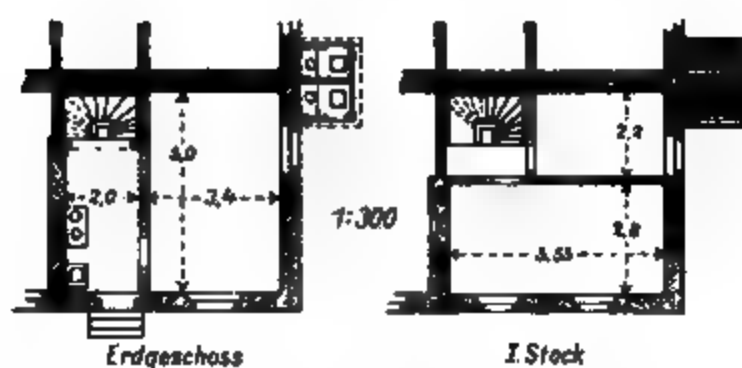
Grundriss der Mülhäuser Vierhäuser.
